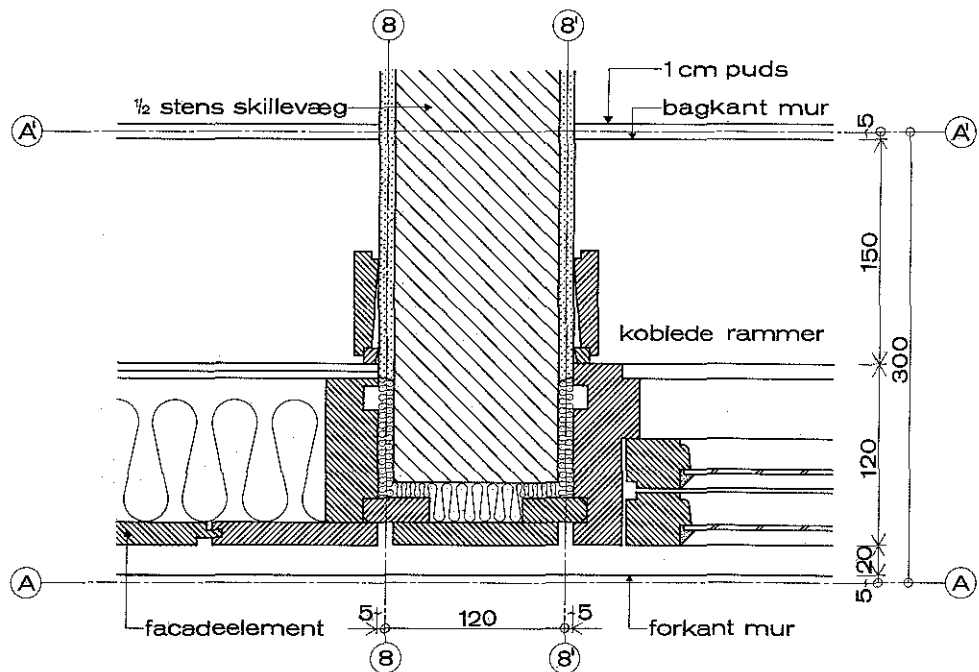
Samling mellem vindue, facadeelement og 1/2-stens tværvæg.
